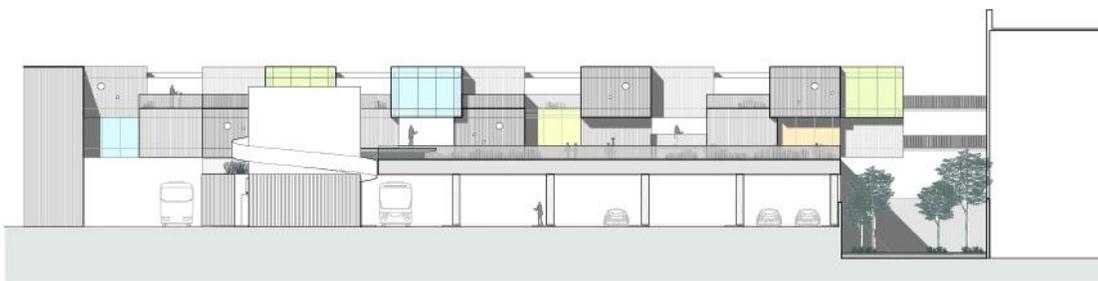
Fachada principal. Fuente ArchDaily [www.archdaily.mx](http://www.archdaily.mx)
